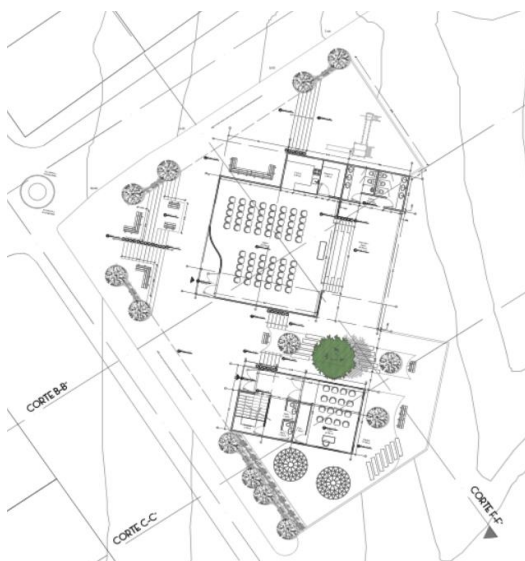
Planta de Primer Nivel Proyecto Salón Social las Margaritas.
